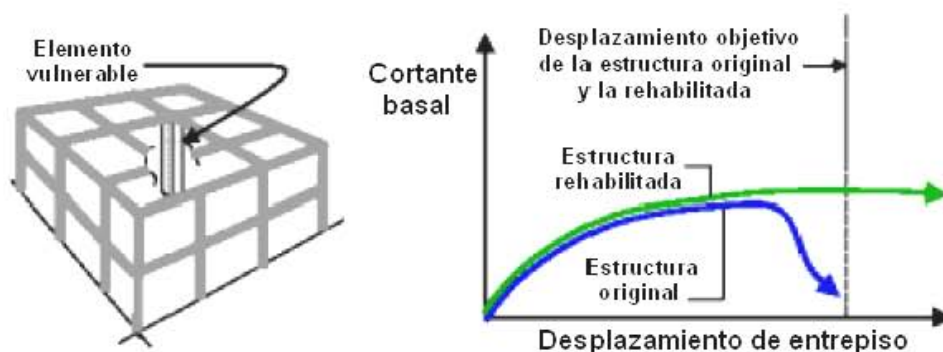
Modificación local de elementos estructurales (Moehle, 2000)
